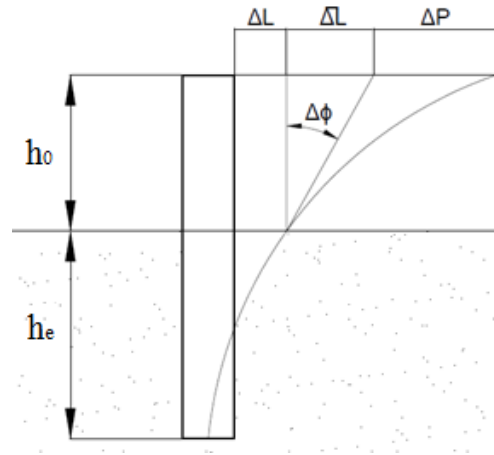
Deslocamento do conjunto fundação-pilar (Marchetti, 2008)
